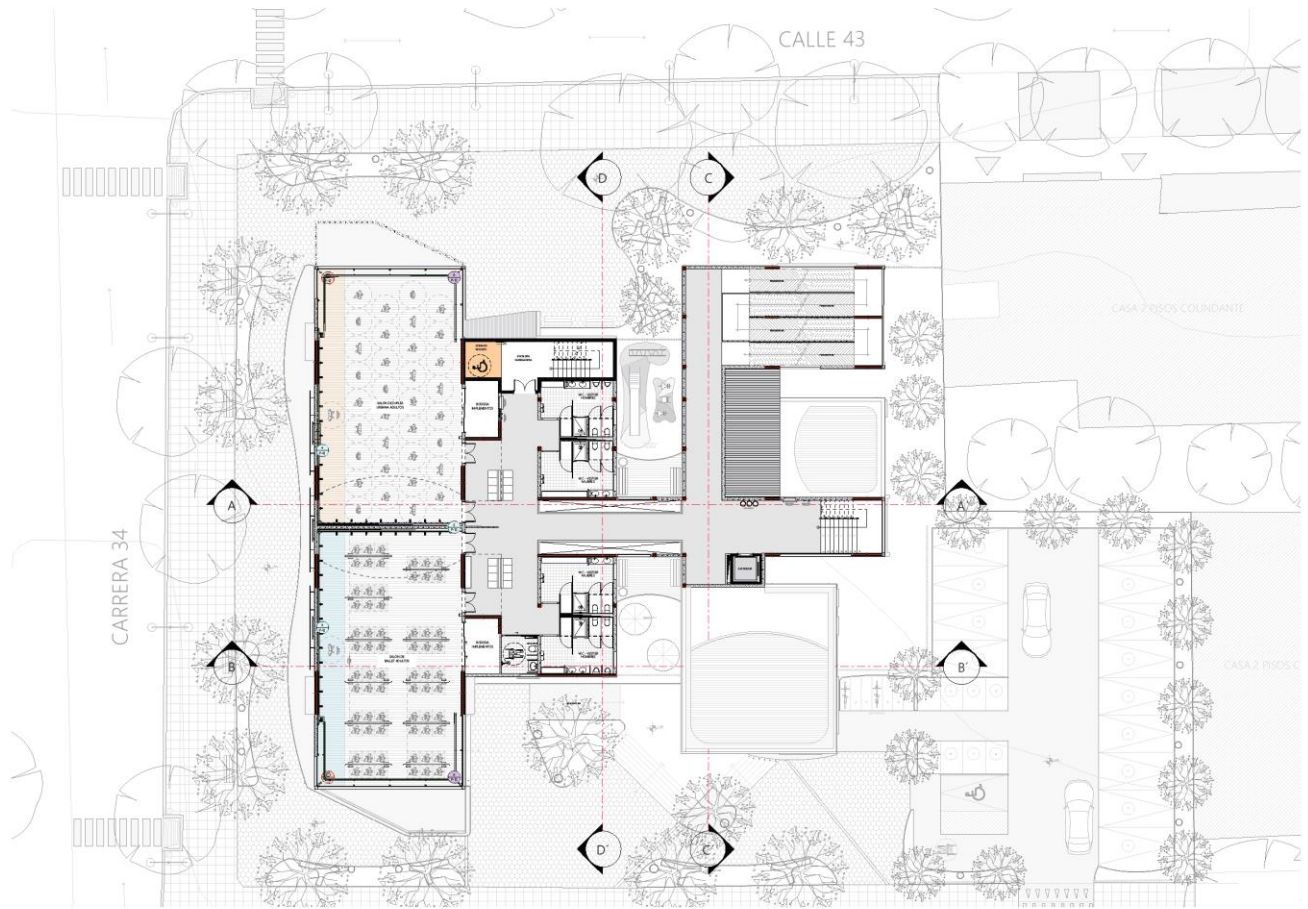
Quinto nivel*6.9.6 Planta Tipo: Sexto Nivel
